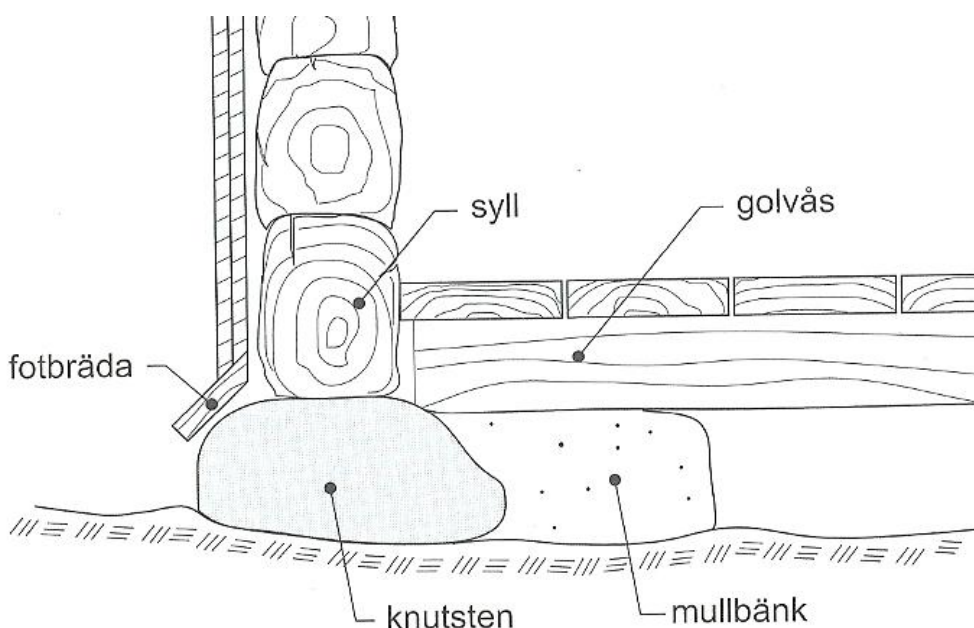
Varianter av krypgrund. Arfvidsson m.fl. s. 165.
